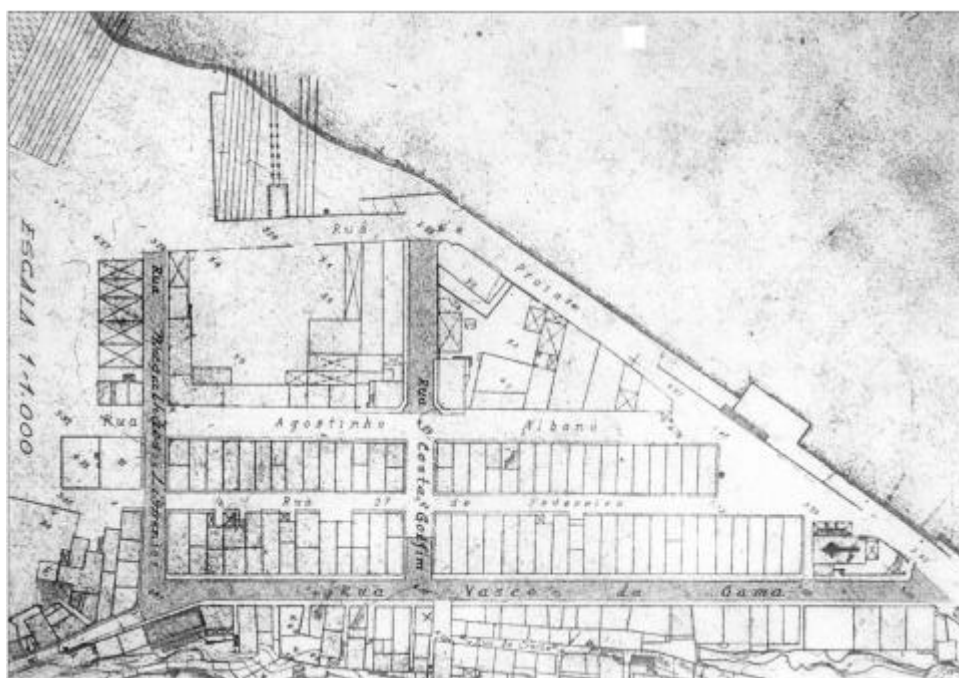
Pavimentação da rua de Vasco da Gama e das travessas de ligação, 1955
